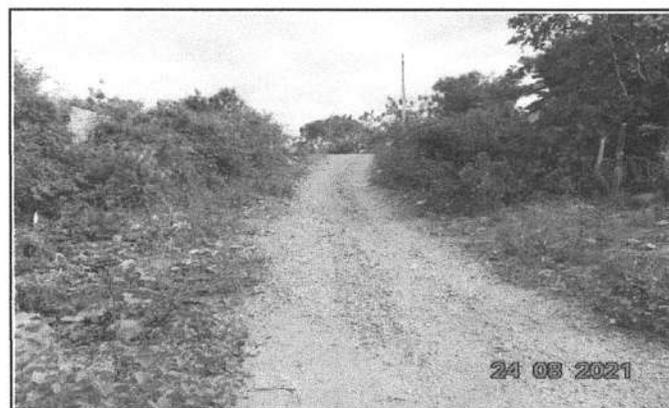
LOCAL DA CONSTRUÇÃO - BUEIRO
